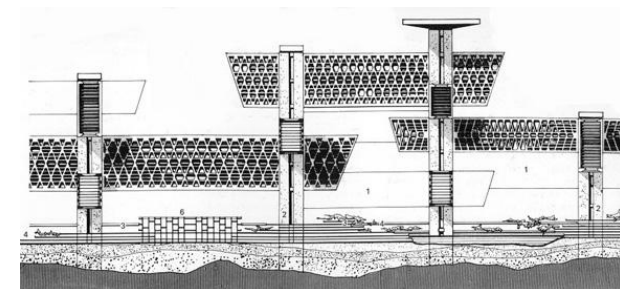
Sección por eje central, Kenzo Tange, 1960.
